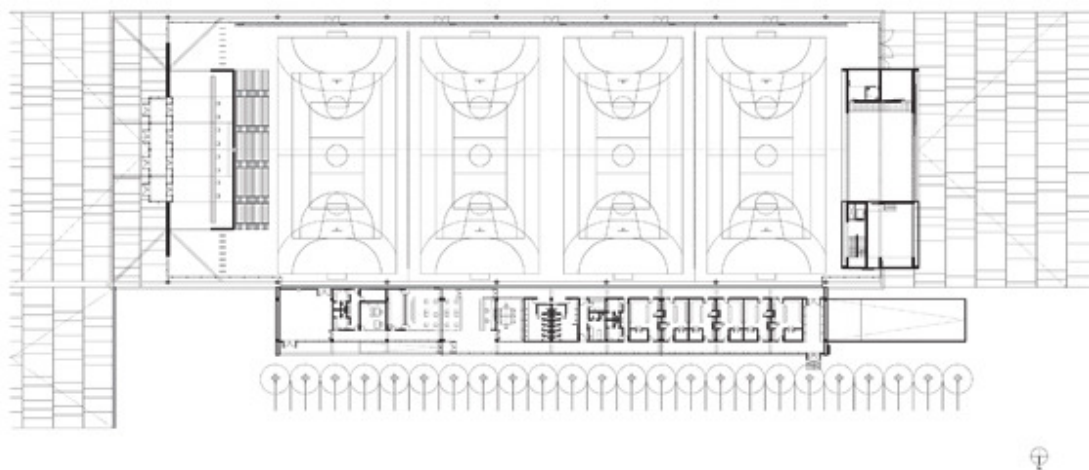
Plantas do projeto do Pavilhão Tortosa.
